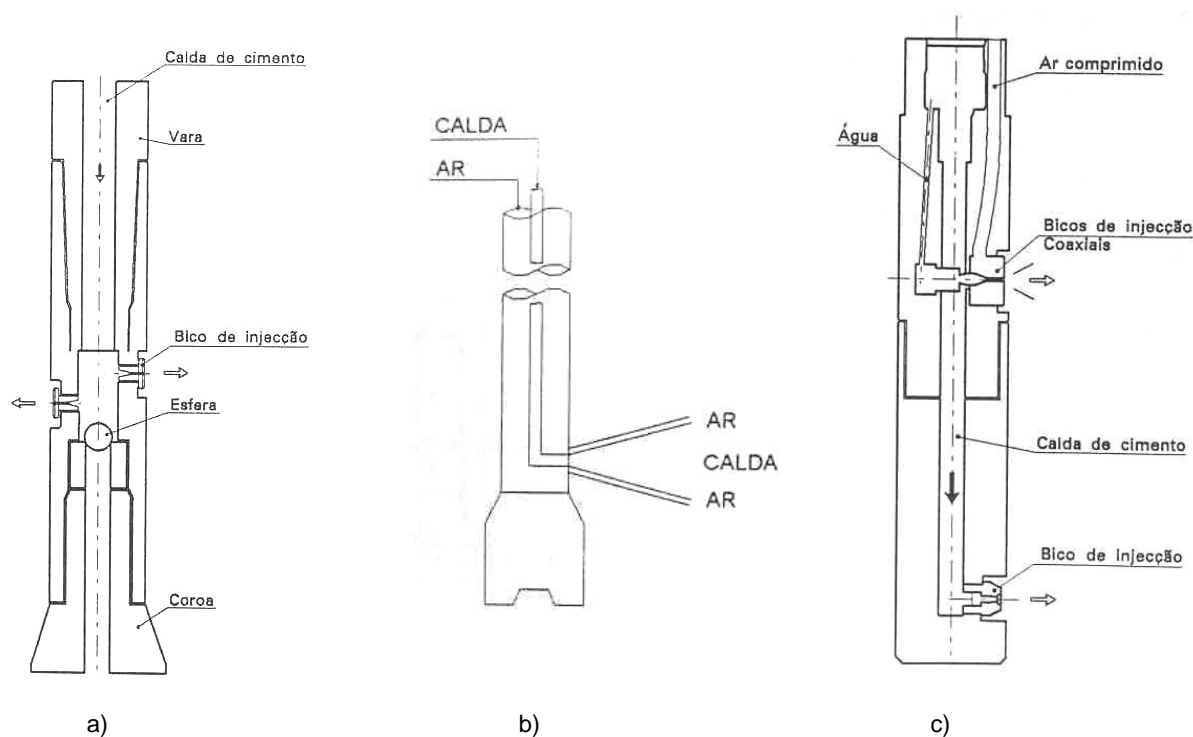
Pormenores da parte inferior da vara para os três sistemas de jet grouting (adaptado de Carreto, 1999):
